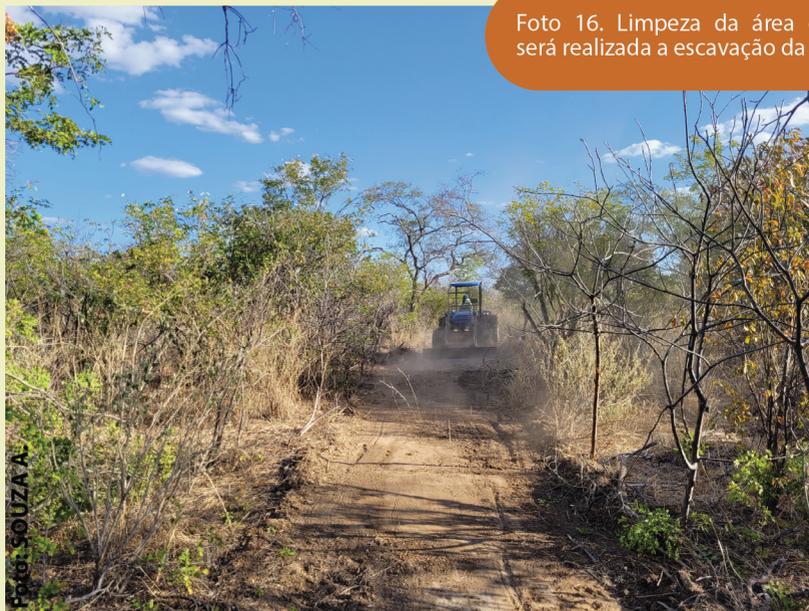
Limpeza da área onde será realizada a escavação da vala.
